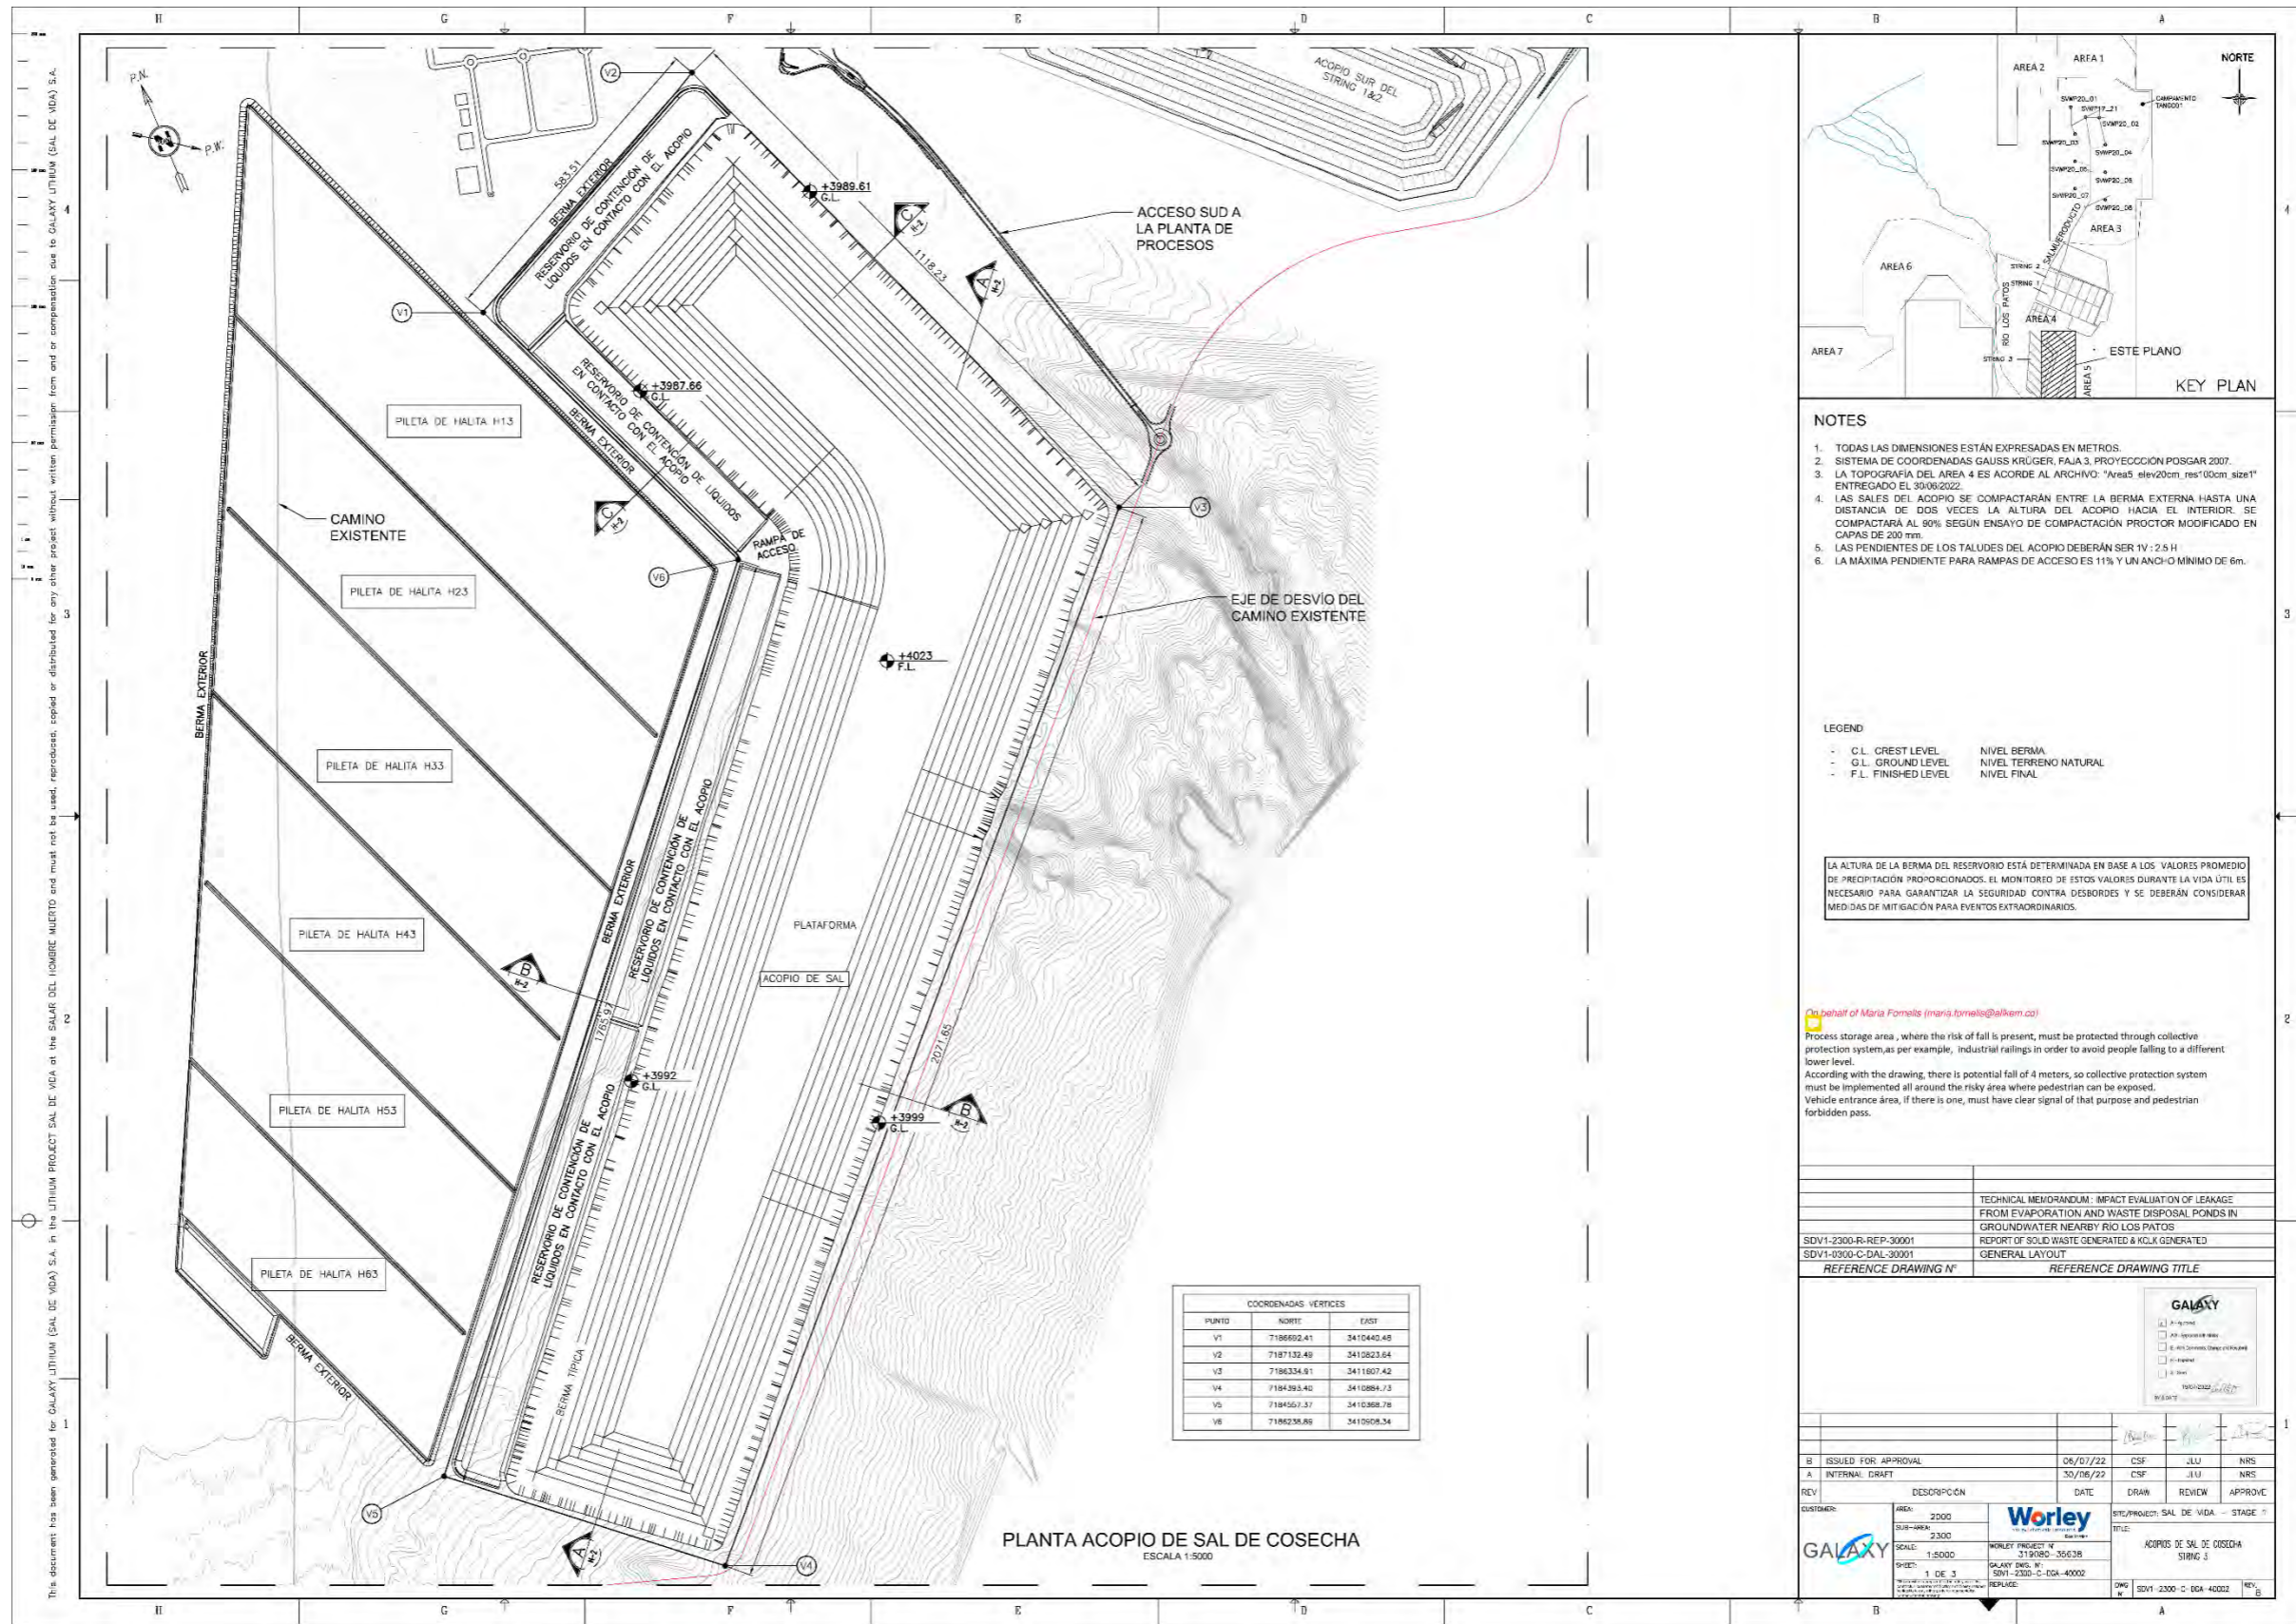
Plano de Las piletas de halita adicionales (String 3).
